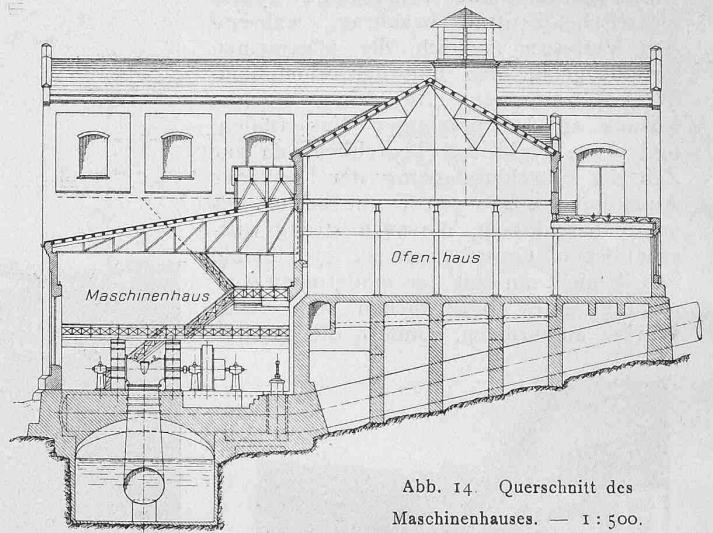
Querschnitt des Maschinenhauses. — 1 : 500.
